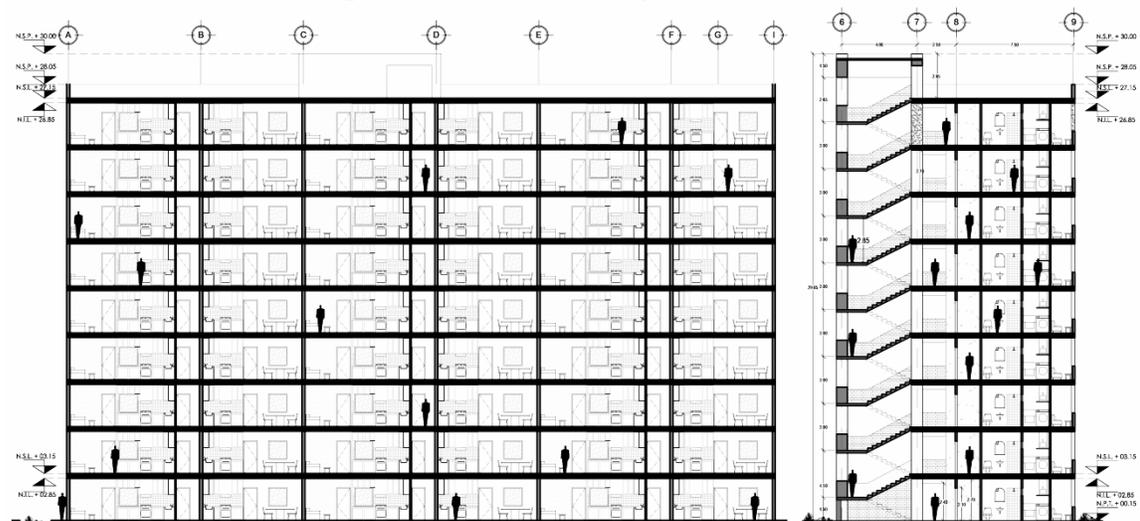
9 Corte longitudinal y transversal, sin escala.
